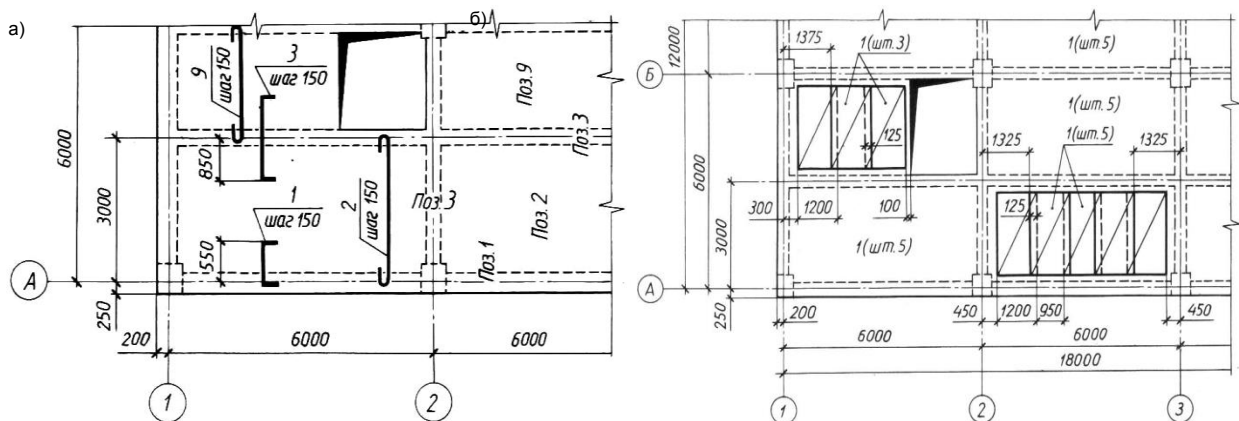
Фрагменти армування плити монолітного перекриття окремими стержнями (а) та зварними сітками (б)
